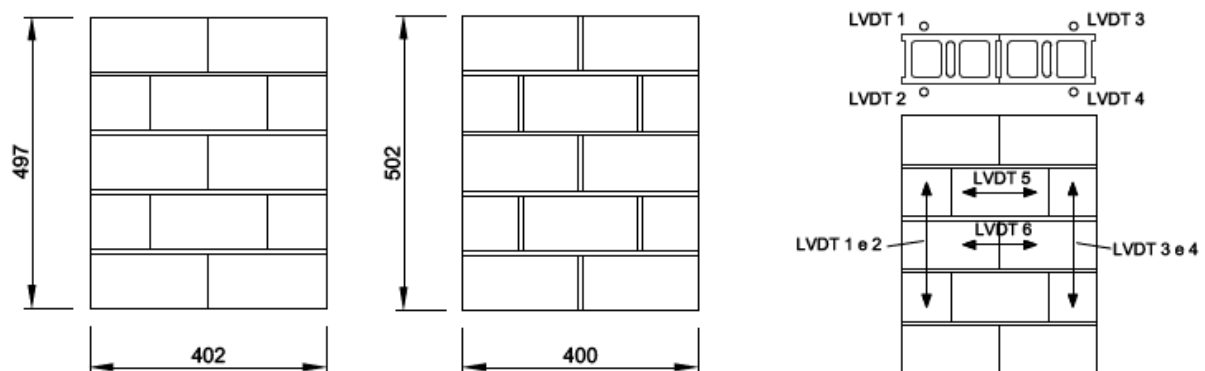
Geometria e instrumentação das paredes para ensaio de compressão uniaxial (GOUVEIA, HAACH et al., 2007).
